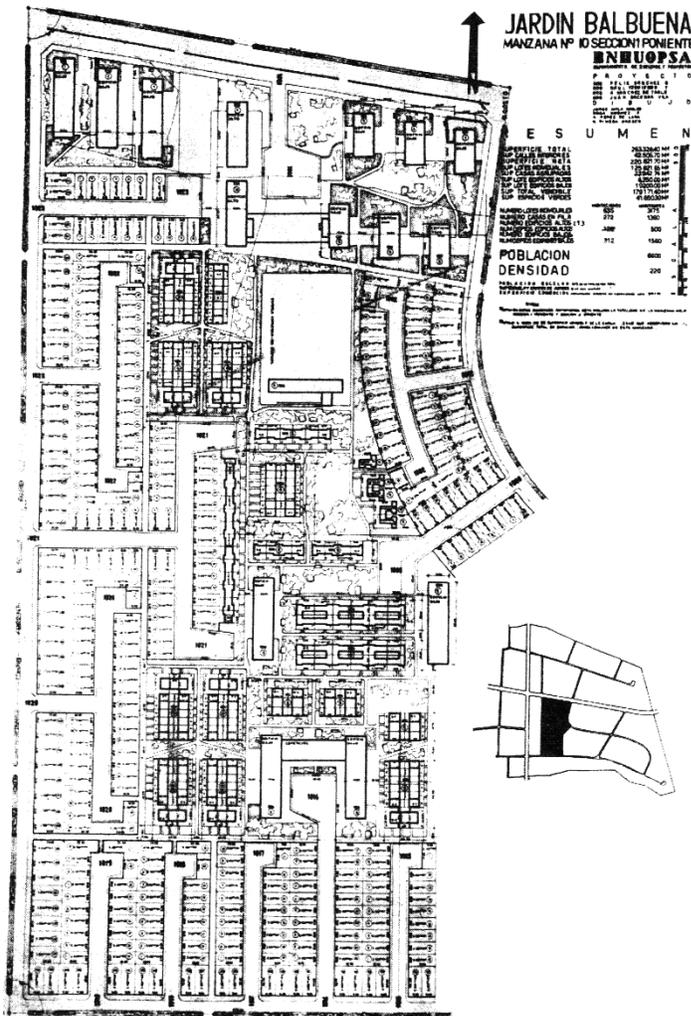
Planta de Conjunto de Jardín Balbuena.
